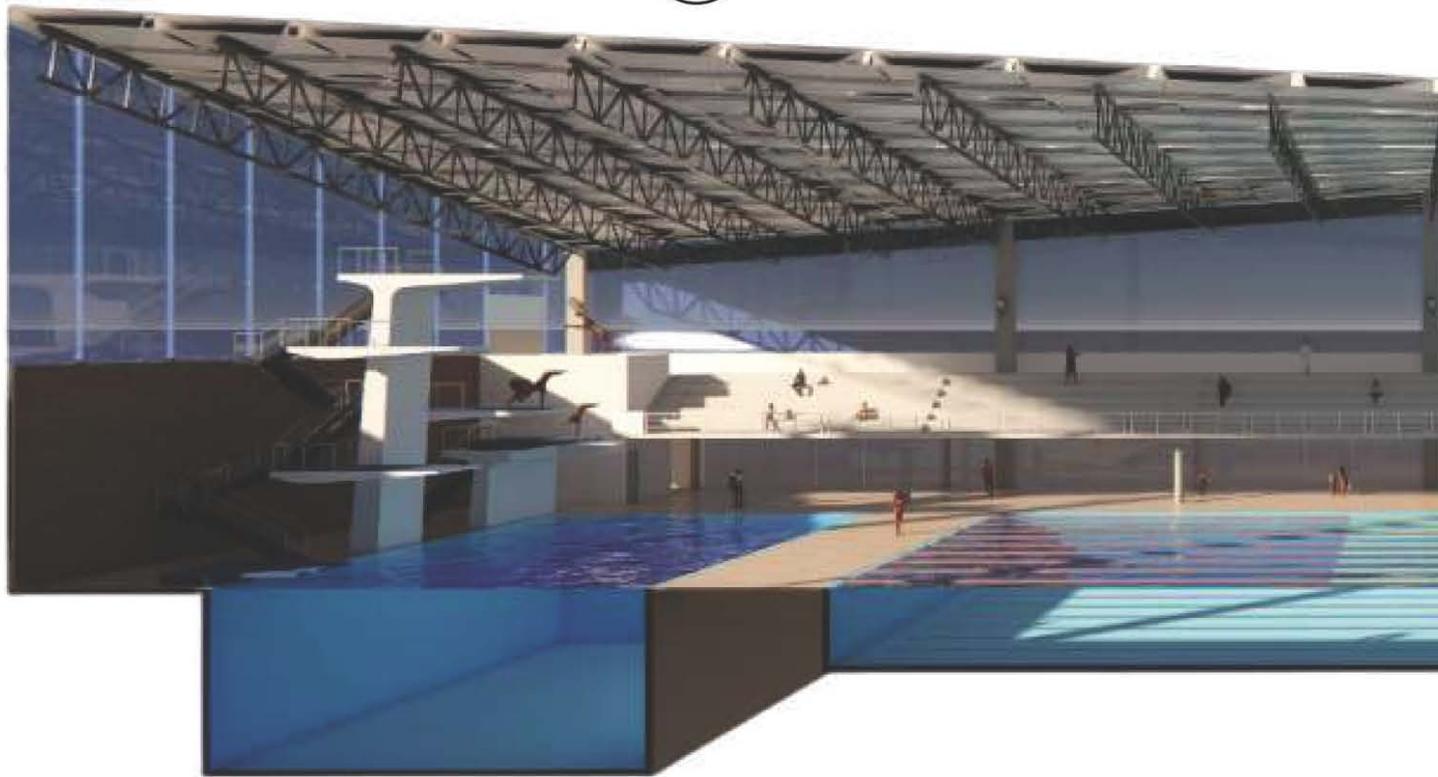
Vista interior del Pabellón Acuático, desde gradas prefabricadas de concreto.
